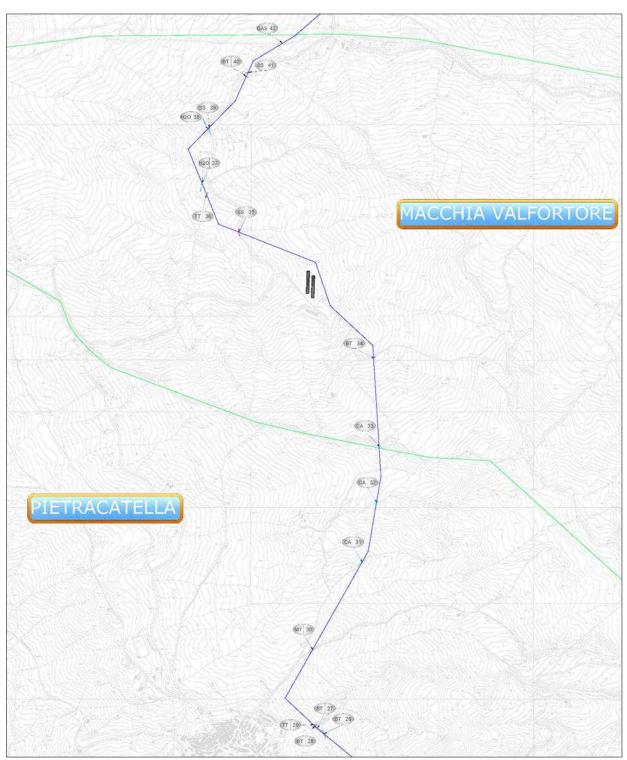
Stralcio planimetria tracciato elettrodotto su CTR (2/5)
